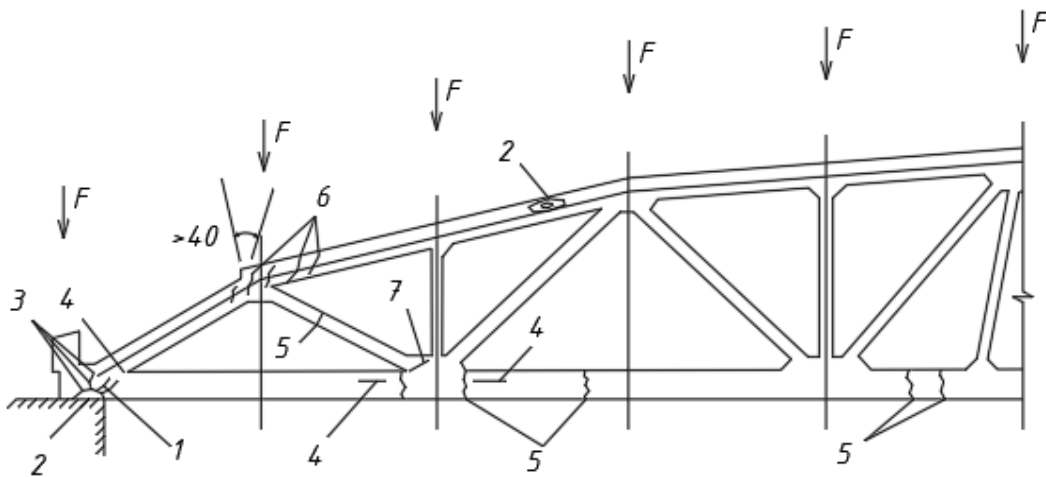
Характерні пошкодження силового походження в залізобетонних фермах з нижнім попередньо напруженим поясом
